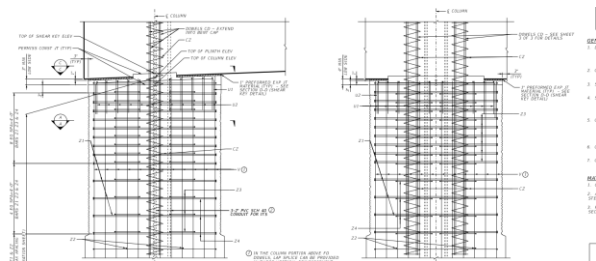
Conexión entre pila y dintel en "straddle bents" con dintel simplemente apoyado.
